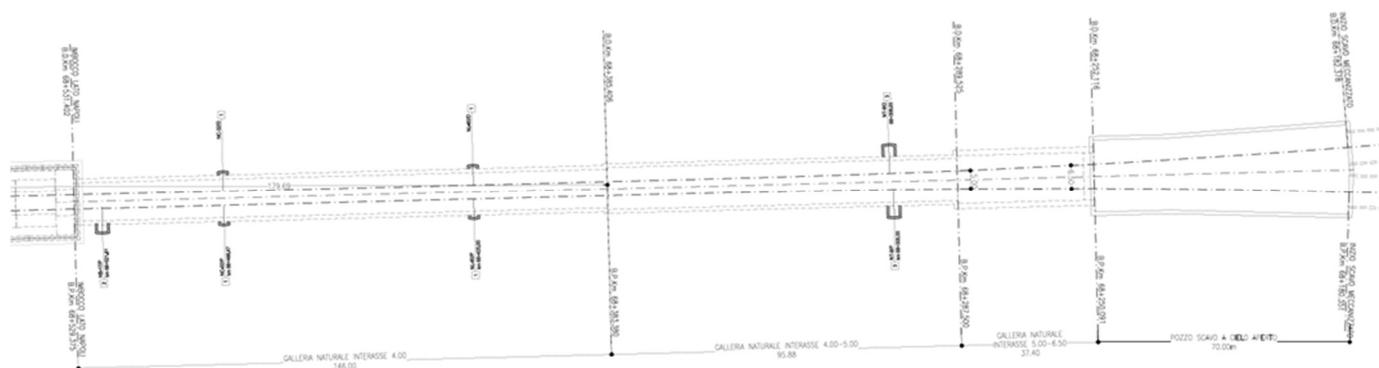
planimetria generale tratta in tradizionale lato Napoli
